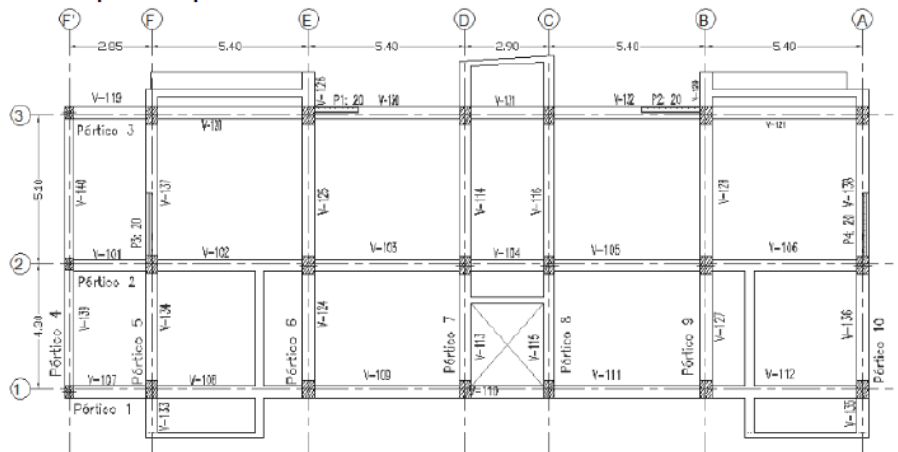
Planta de Cimentación Bloque A Torre Típica.
